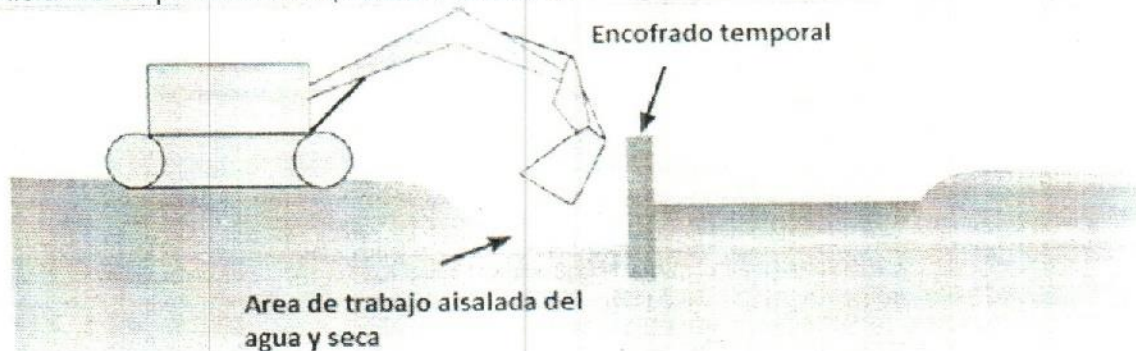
Aislamiento parcial con encofrado. Fuente: Adaptado de *Engineering in the water environment. Good Practice* SEPA 2009
